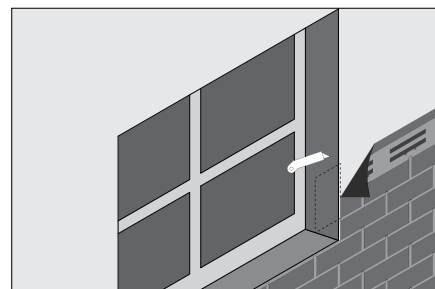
Монтаж фасадной плитки вокруг оконных проемов
